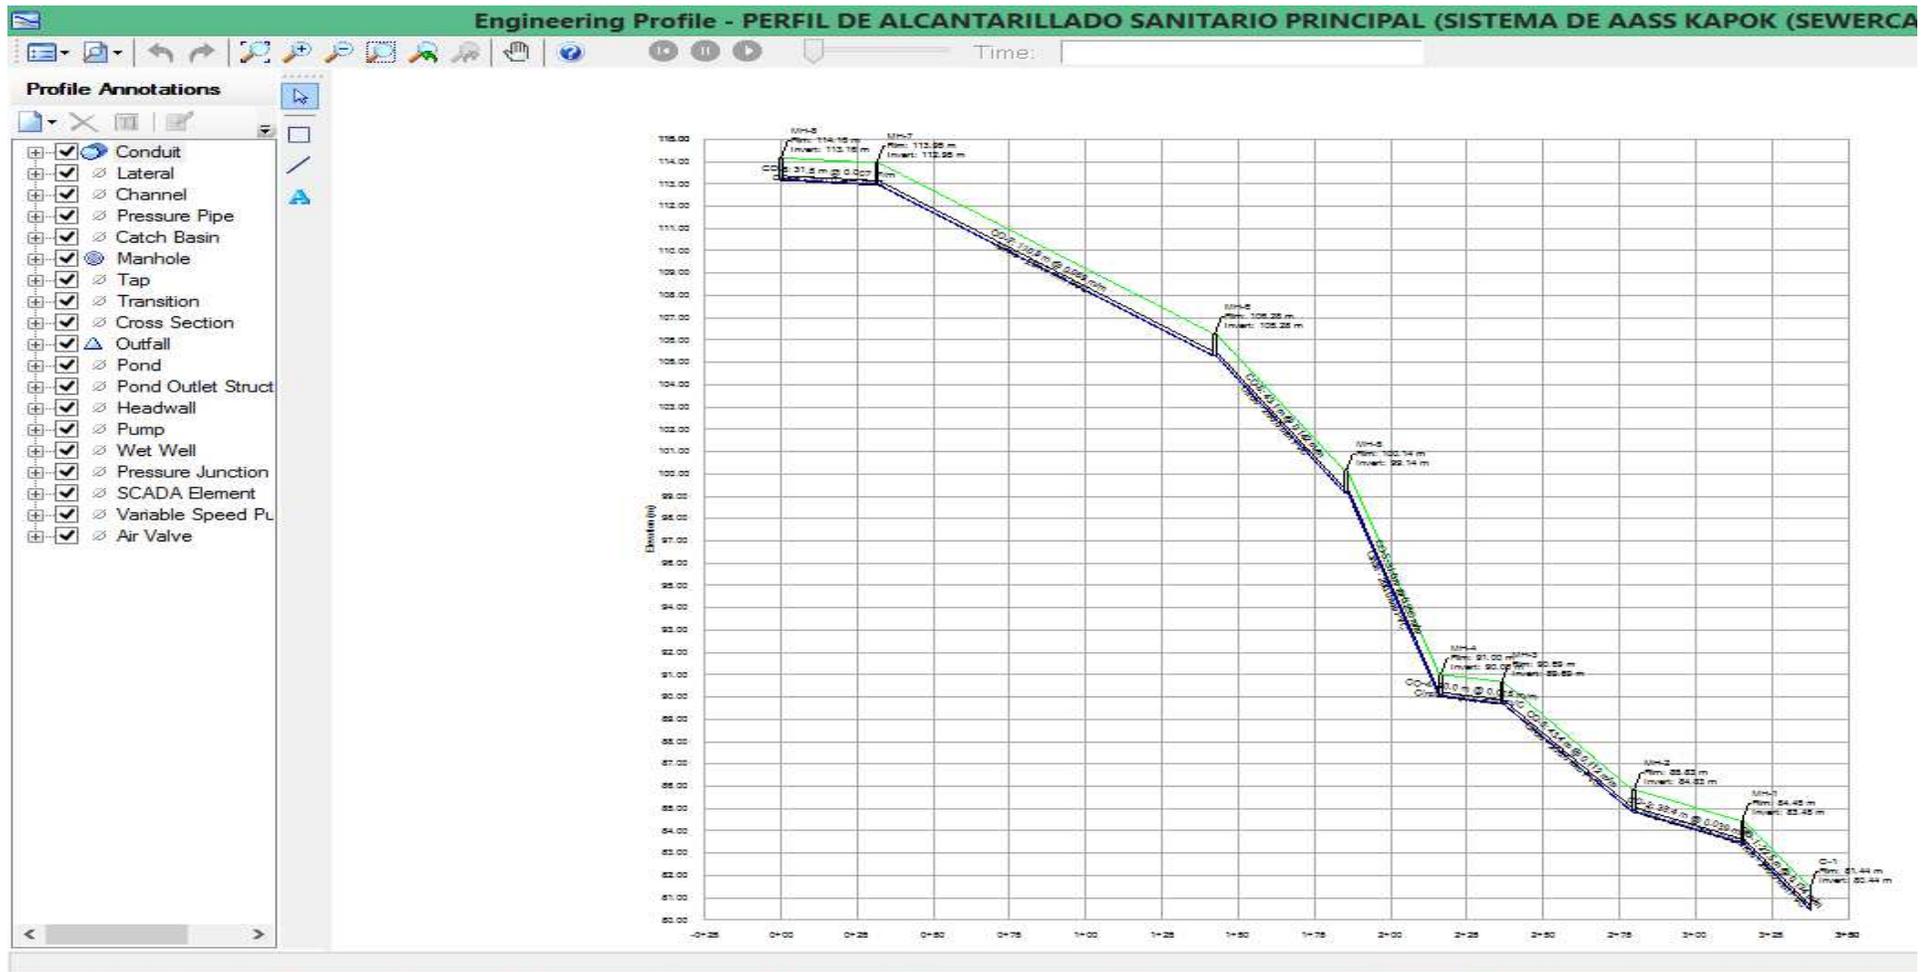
Perfil de Ingeniería de la urbanización "Colinas de Kapok"
